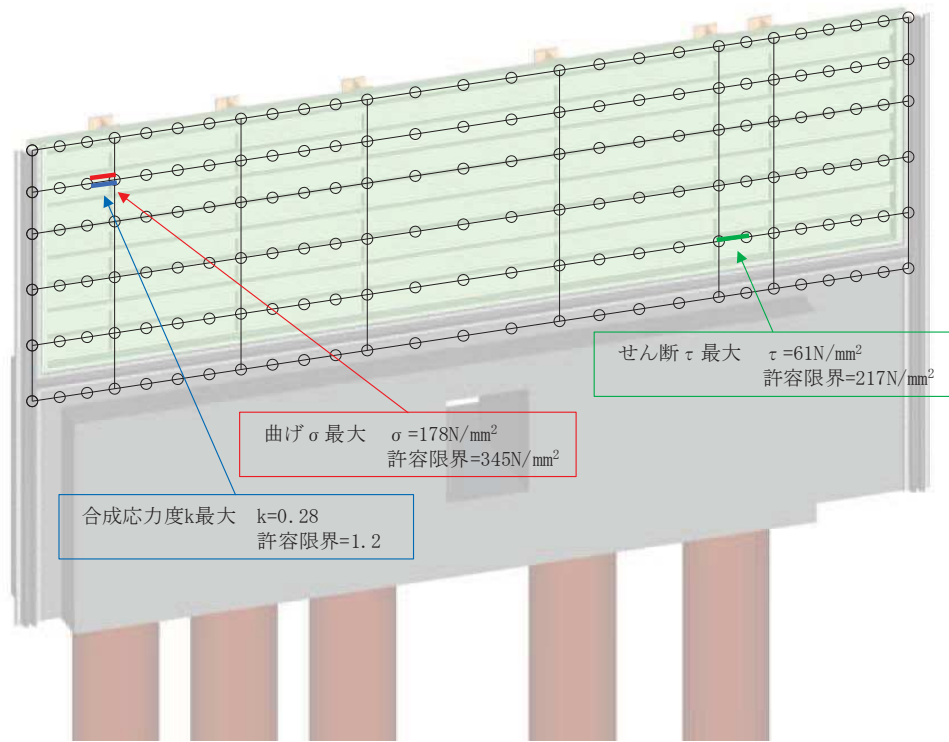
鋼板の曲げ・軸力系の破壊及びせん断破壊に対する
